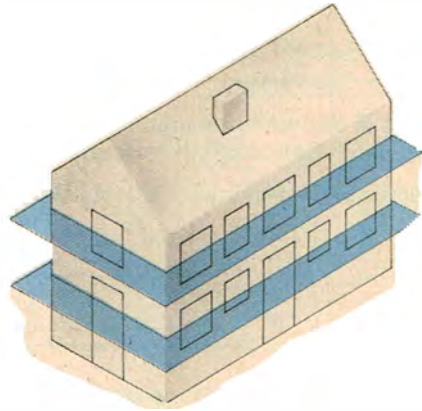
Horizontalschnitte (Grundrisse)
